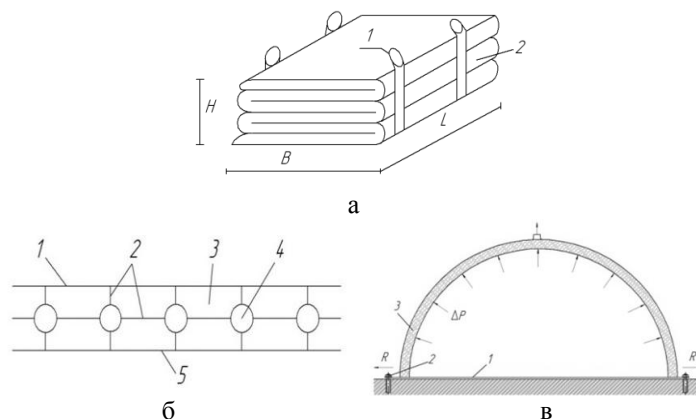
Быстровозводимое сооружения на базе пневматической опалубки.
